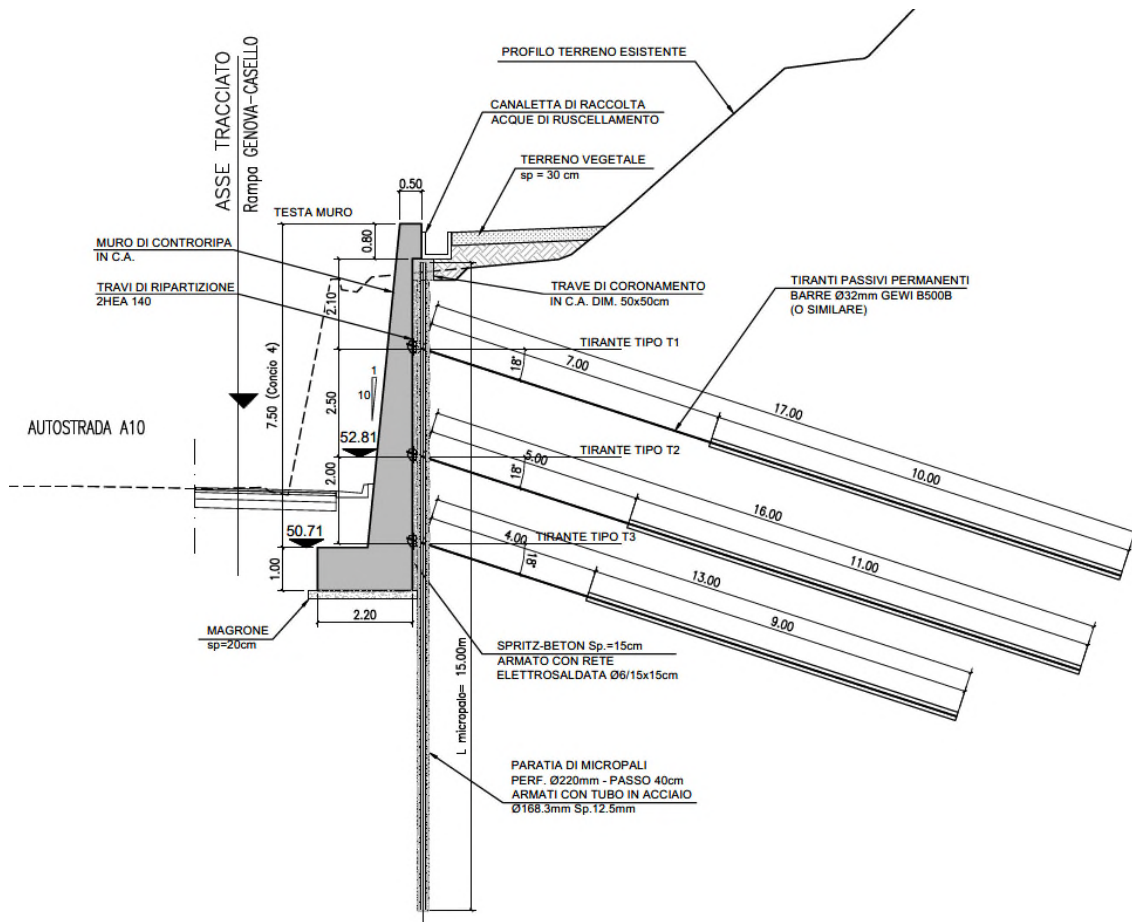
Sezione tipologica berlinese multi-tirantata rivestita da un muro di placcaggio
